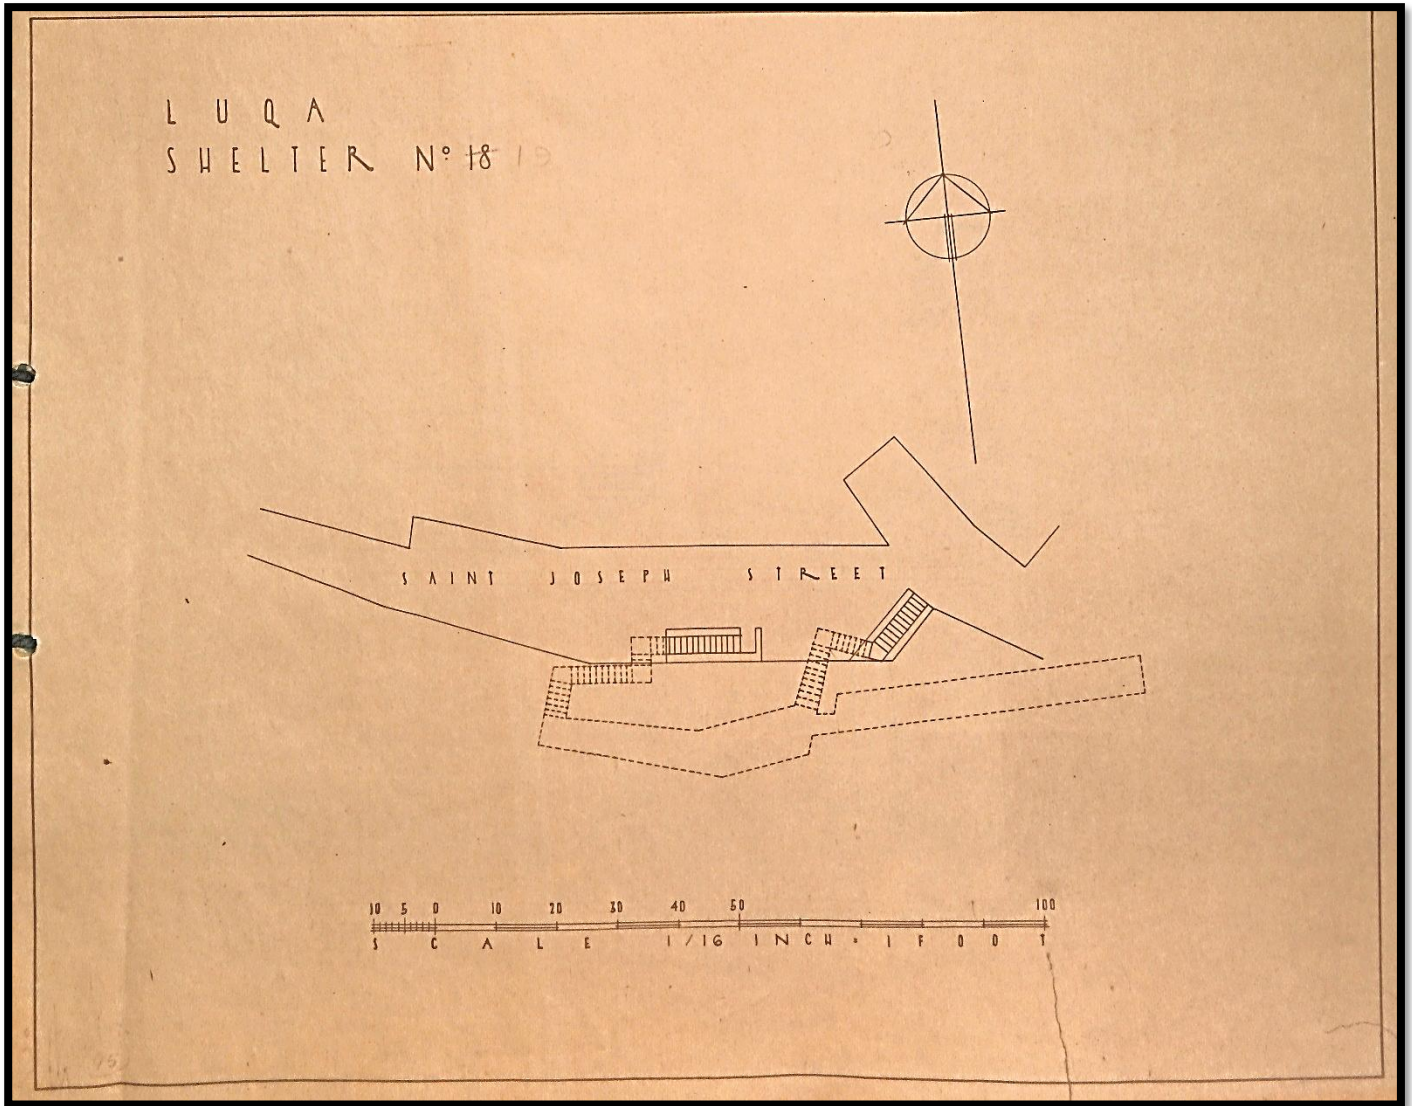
Planta do Abrigo nº18 (19) "Saint Joseph Street"
